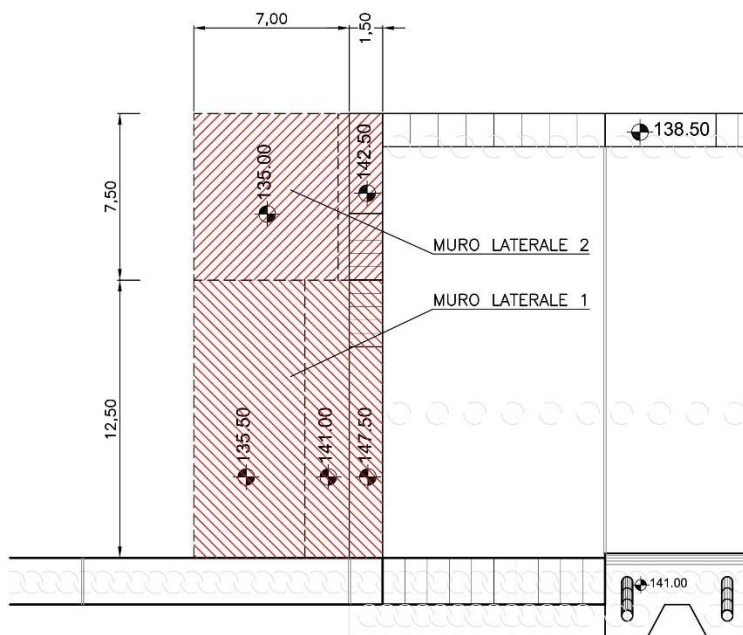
Planimetria con identificazione dei muri laterali 1 e 2
